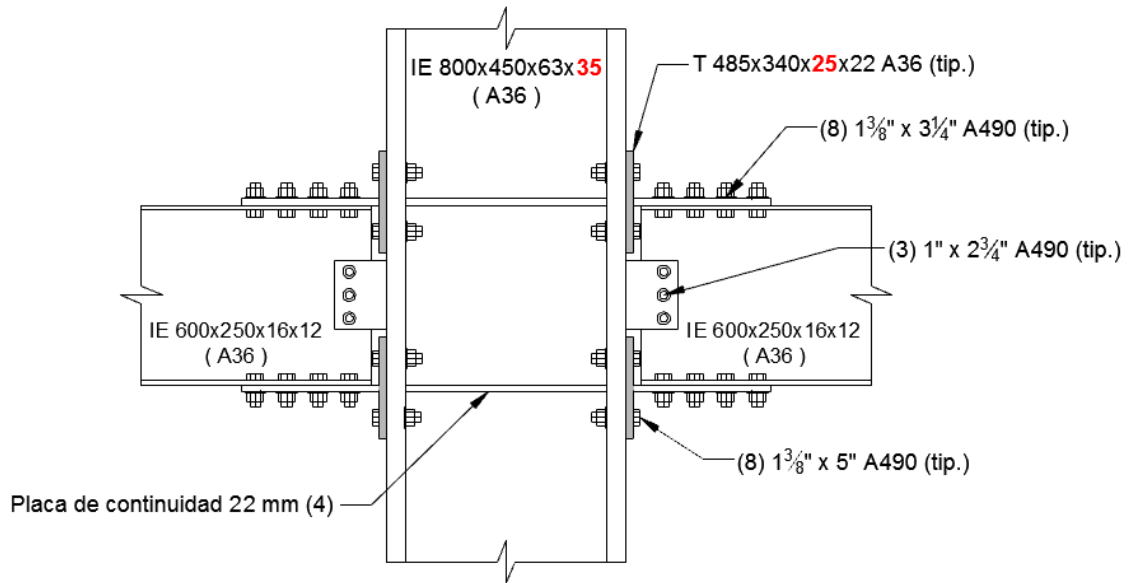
Detalle de conexión de SE-01(DBT2).
